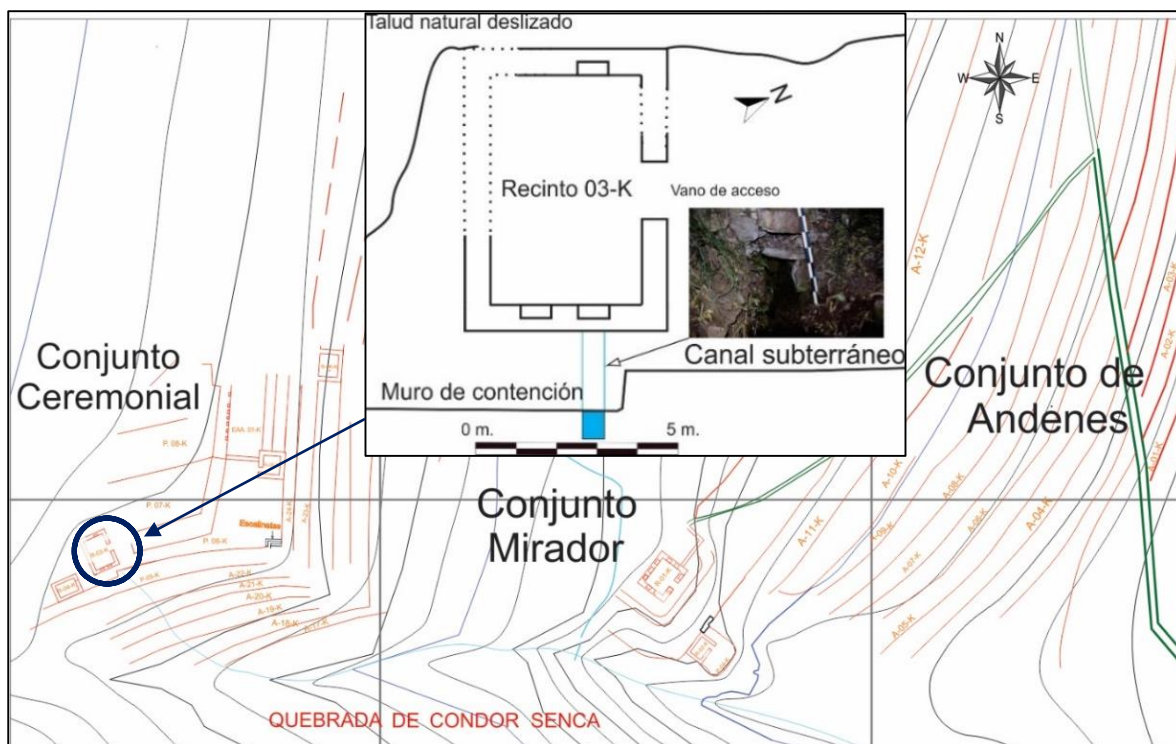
Plano de planta del Recinto 03-K, muro de contención de la plataforma 06-K, y canal subterráneo, ubicados dentro del sitio Khiskipata. Elaboración propia.
